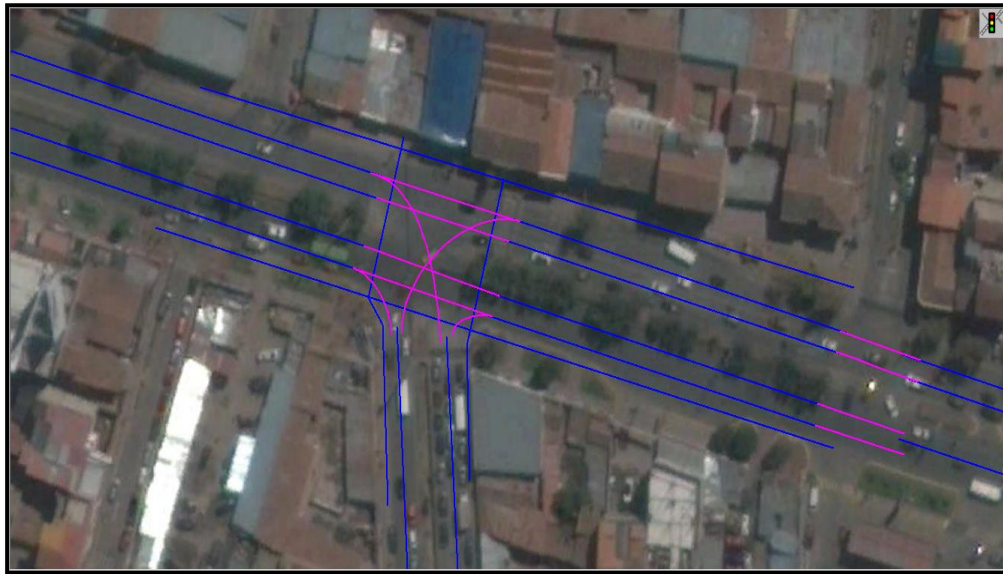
Vista en planta de la Intersección Av. La cultura – Manuel Prado
